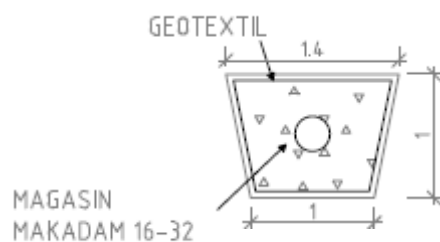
Erforderligt magasin. Efter drygt 30 minuter erfordras inget större magasin för att fördröja 10-års regnet.
